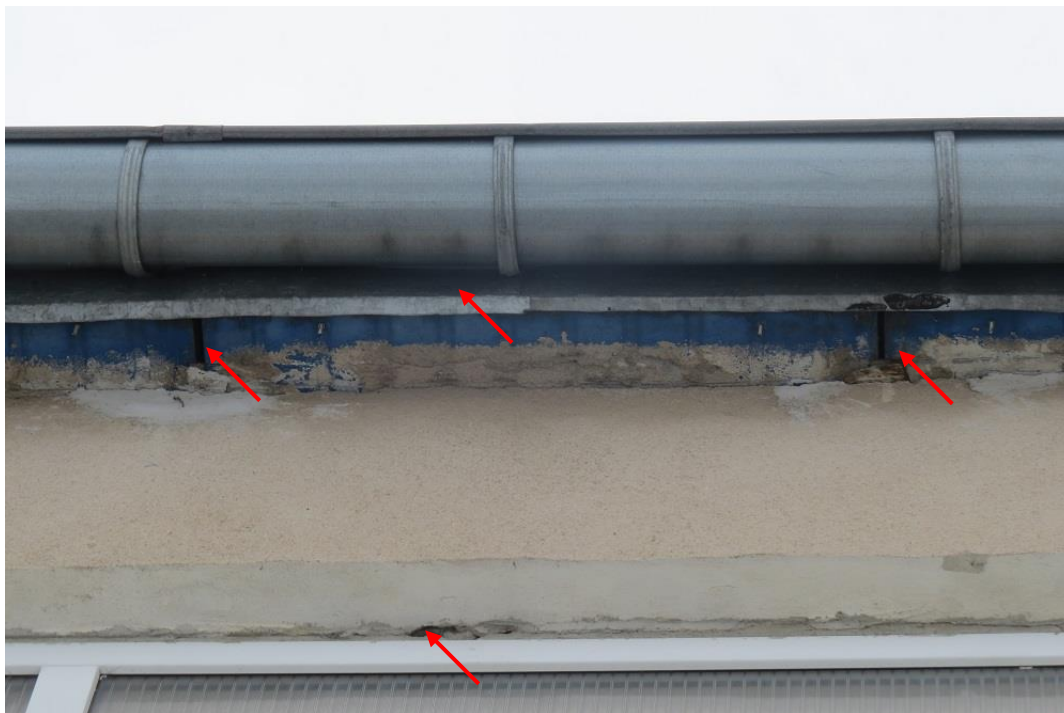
Ubytki w górnej części elewacji na krawędzi styku ściany z dachem.
